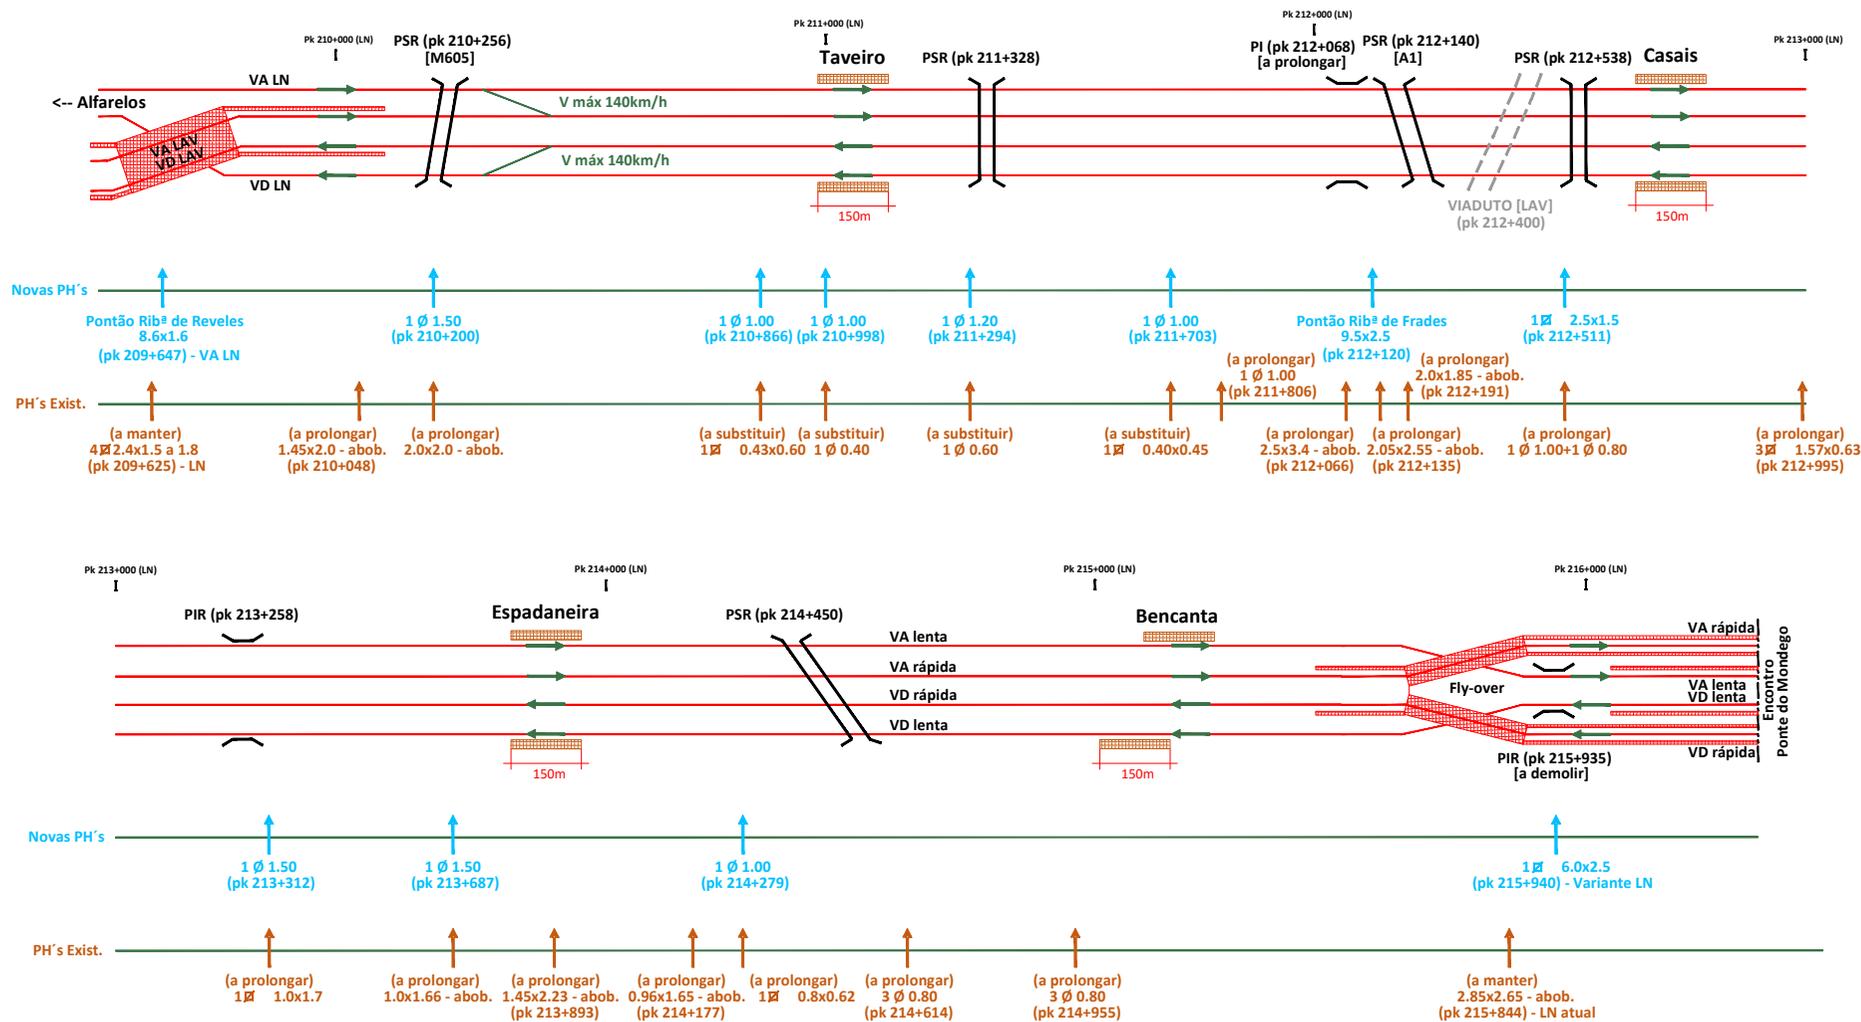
Esquema de Localização das PH' s entre Taveiro e Bencanta
